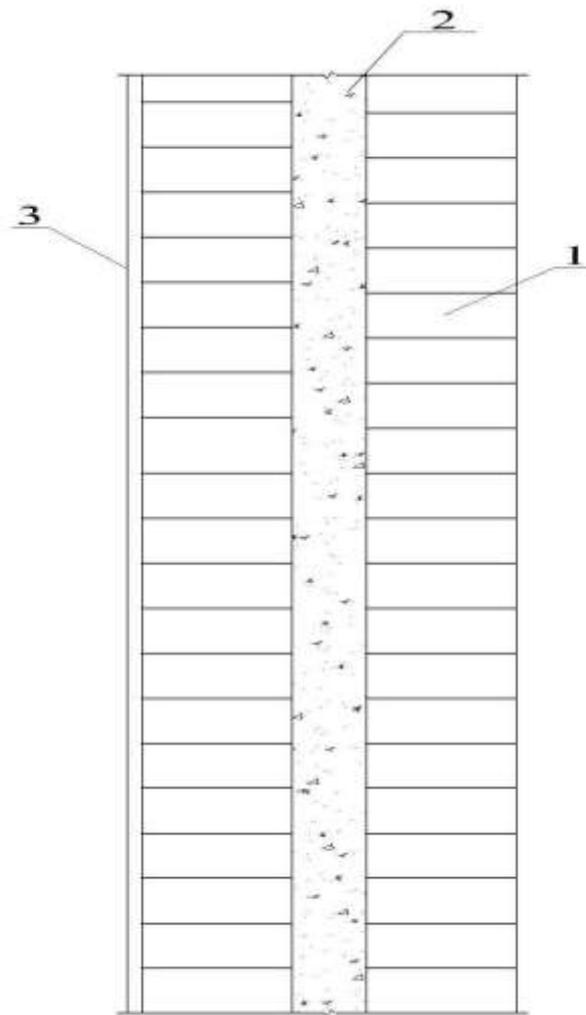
Схема наружной стены с монолитным теплоизоляционным слоем из пенобетона пониженной плотности:
